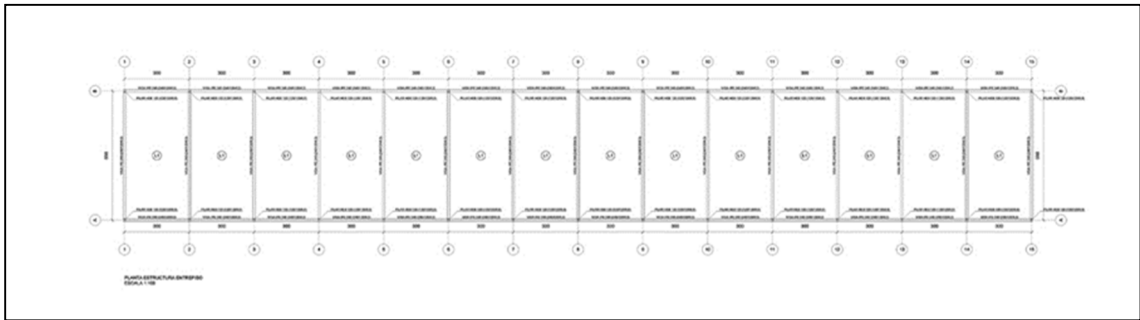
PLANTA DE ESTRUCTURA DEL " PABELLÓN PORTUARIO "
